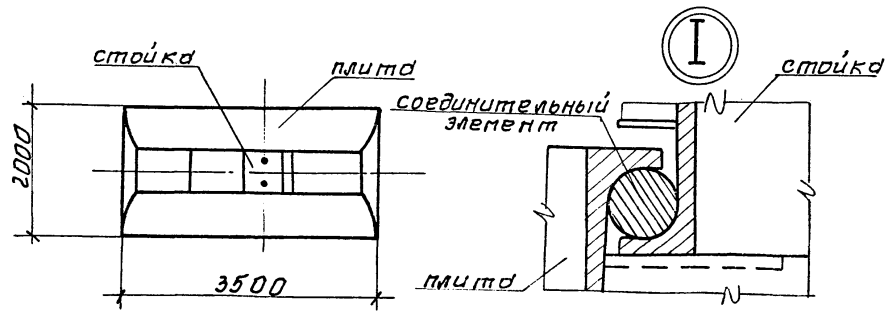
Конструкции унифицированных железобетонных элементов фундаментов
